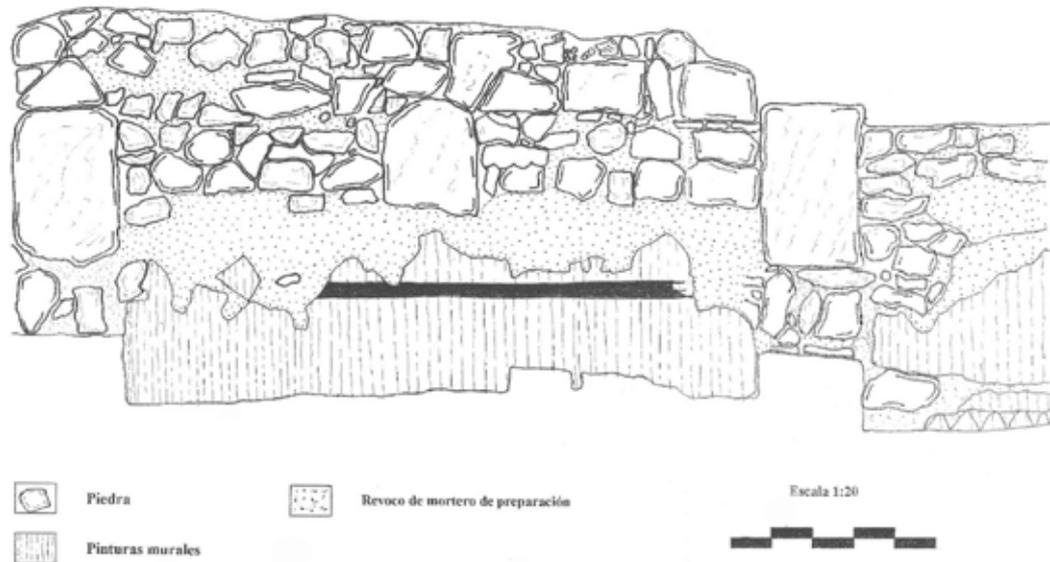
Alzado sur del muro 17 en el espacio 6 (diseño de C. Pacheco).
